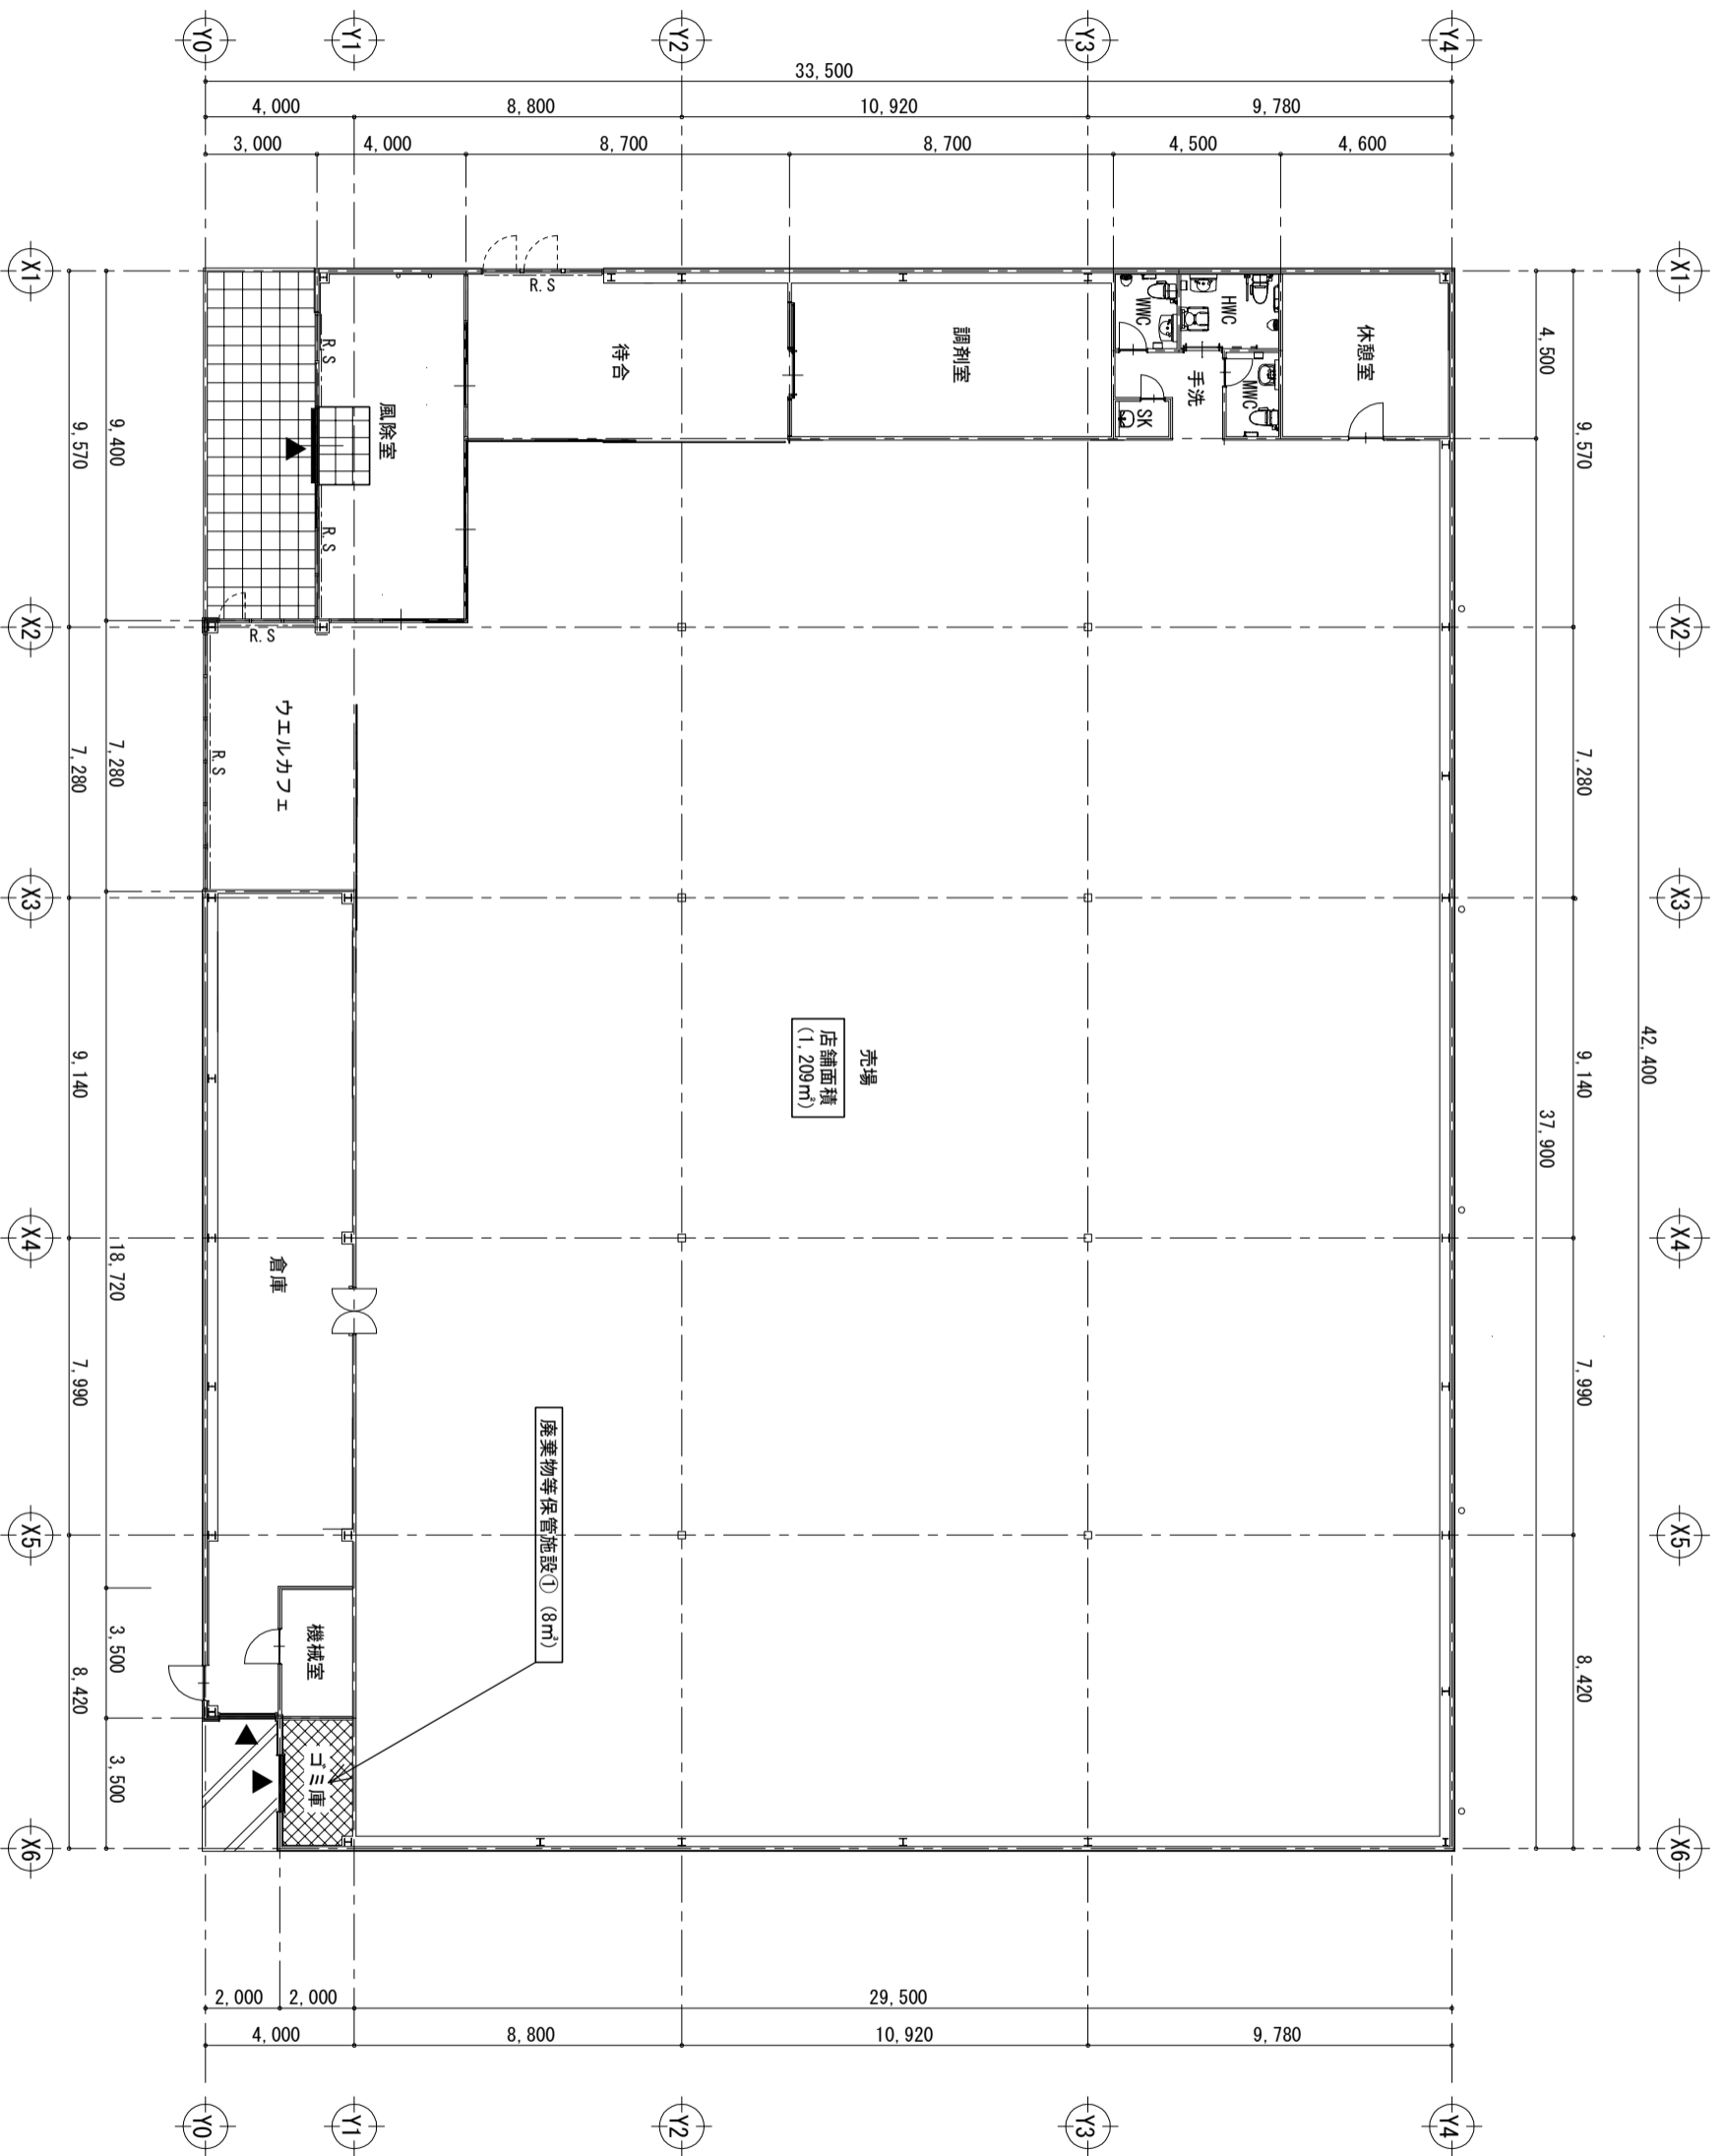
1階平面図・ウエルシア薬局棟 (S=1/200)
